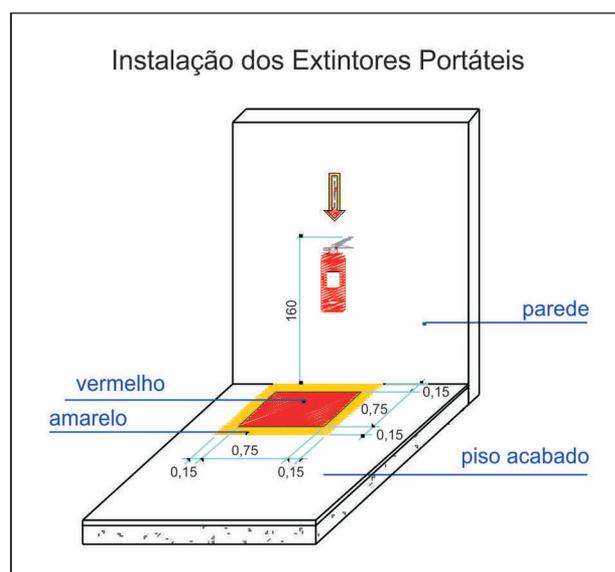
Detalhe de instalação de extintores em áreas sujeitas à obstrução
